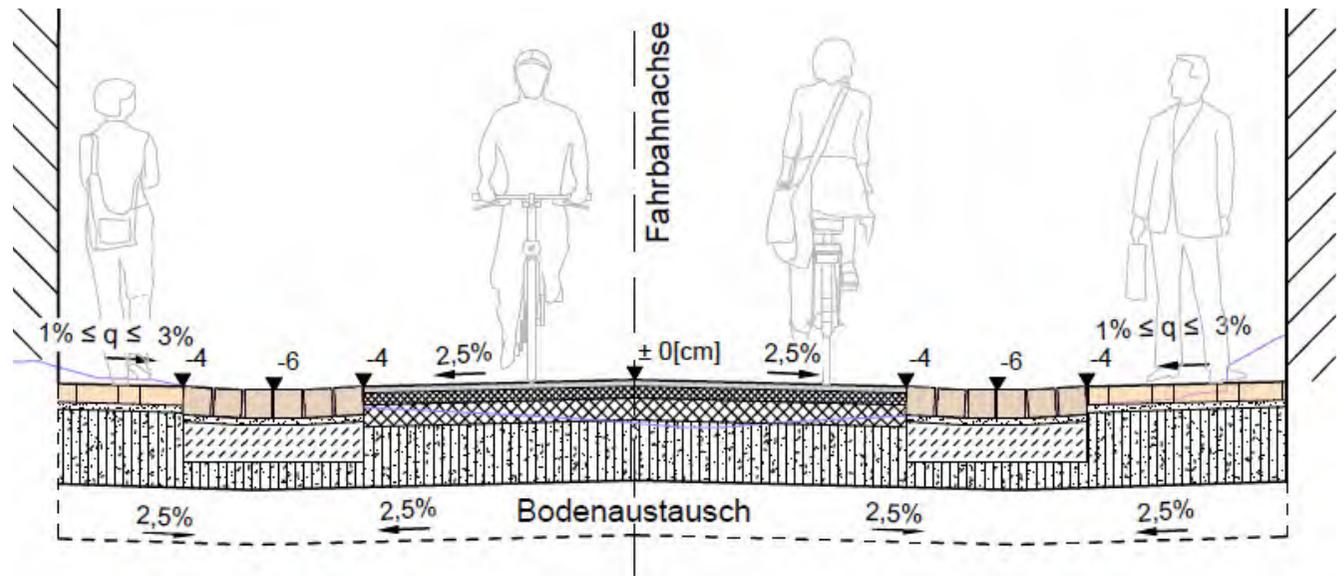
Querschnitt Ausführung Fahrradstraße Wallgraben/Apothekengasse
